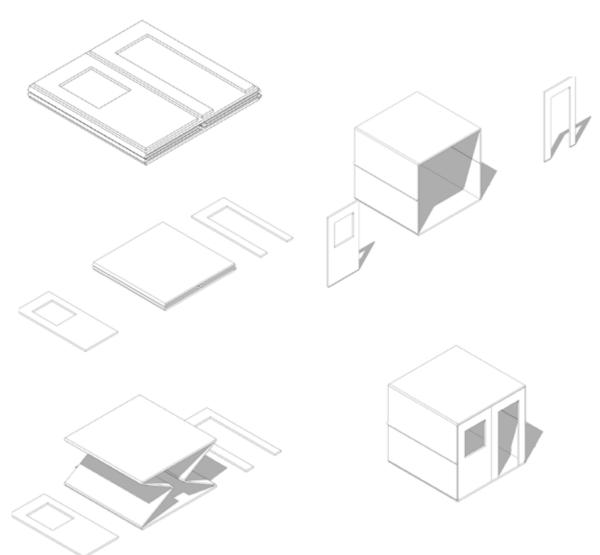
Característica plegable y Transportable del sistema Constructivo FUENTE: Autoría propia
